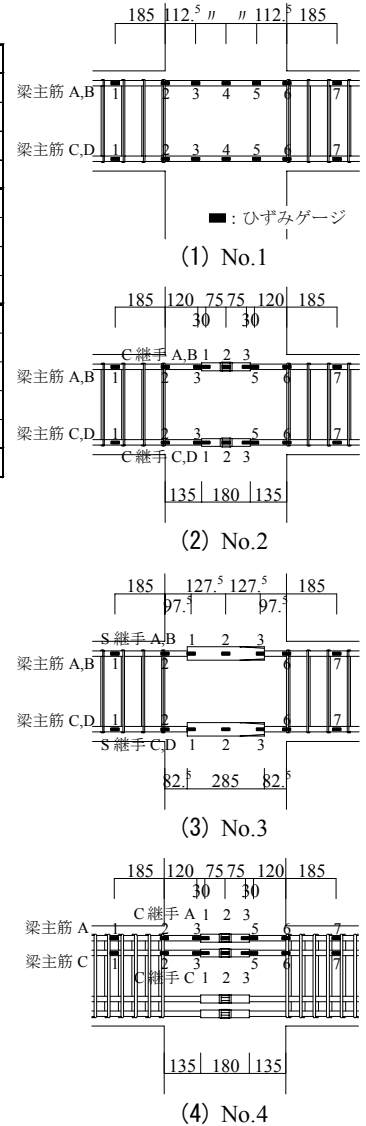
柱梁接合部内の配筋状況とひずみの計測位置
